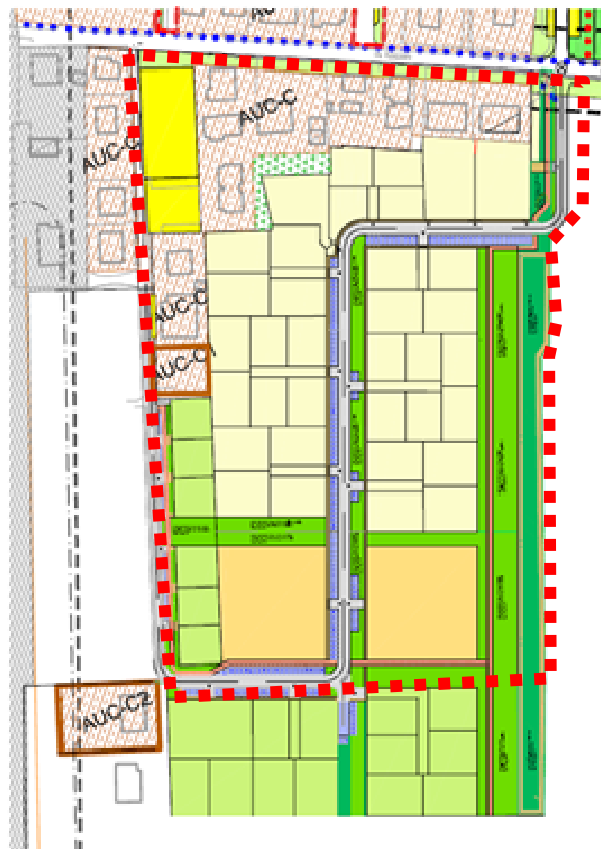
Planimetria progetto Sub-Ambito 5.1
